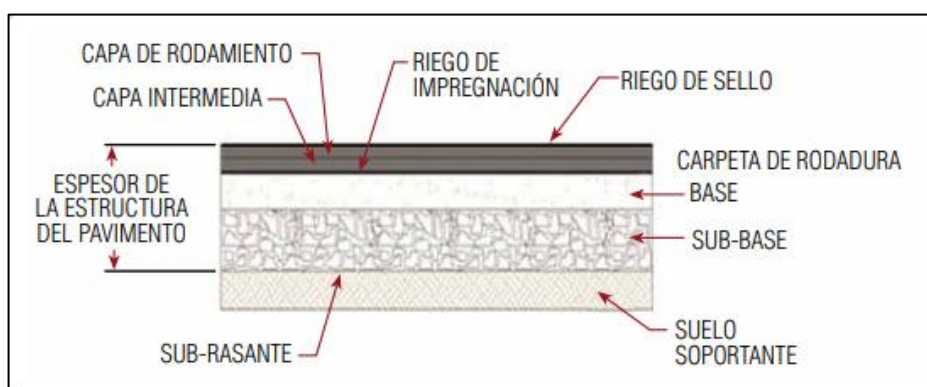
Estructura de Pavimento Flexible (Sección Típica).
